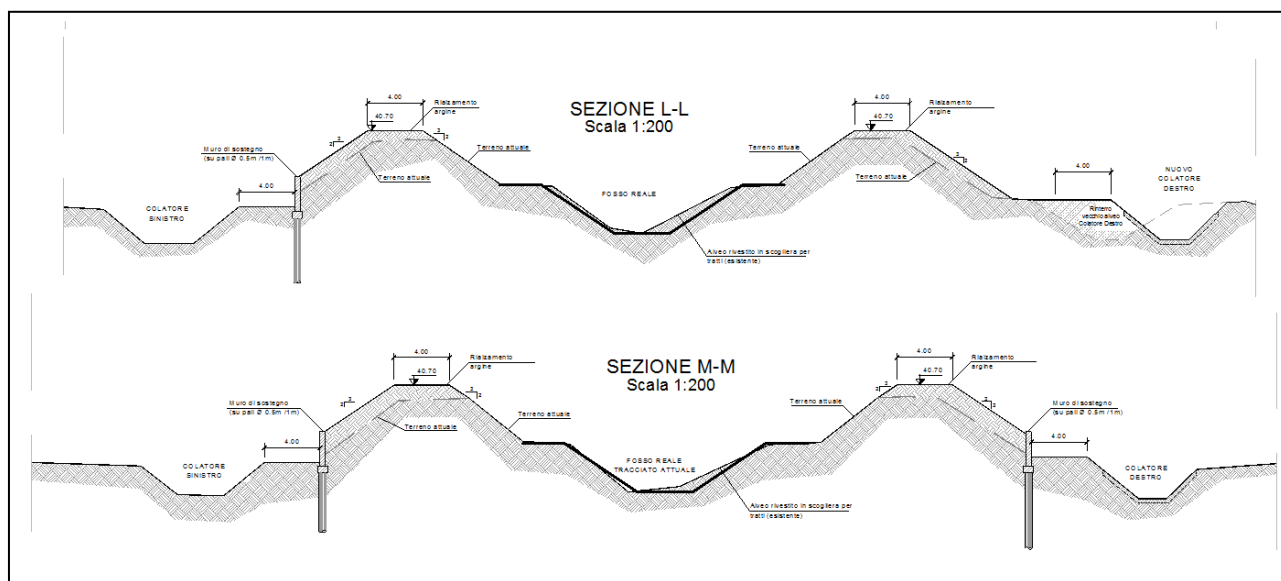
Sezione di progetto Canale Scolmatore tratto esistente da adeguare
